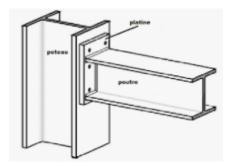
24 : assemblage type poteau-poutre par platine source : internet
